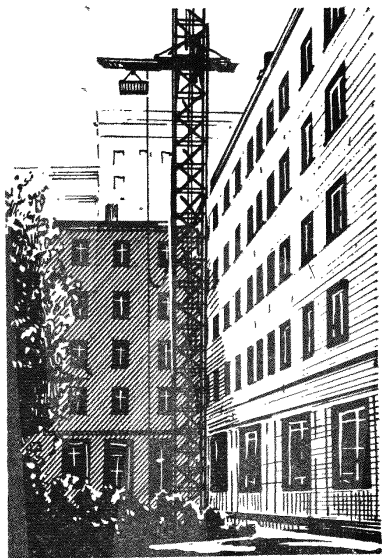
Передвижной строительный подъемник СП-06 на ремонте пятиэтажного жилого дома в Москве с подачей материалов и конструкций в любой оконный проем и на крышу
